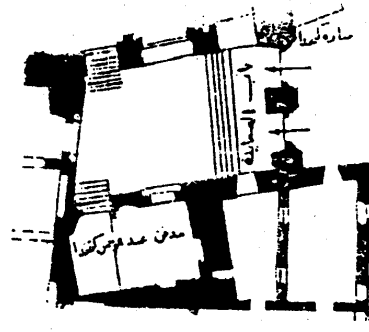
مسقط أفقي للقبّة الملحقة
